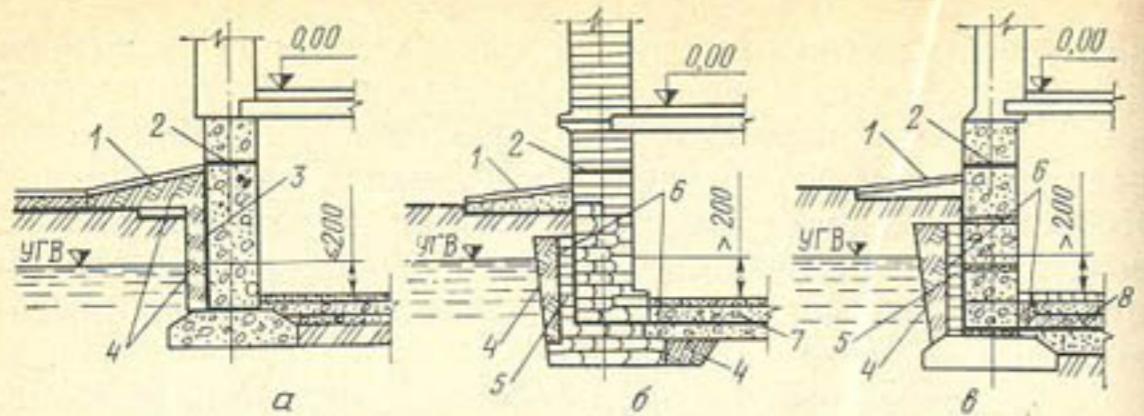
Гидроизоляция фундаментов зданий с техническими подпольями:
